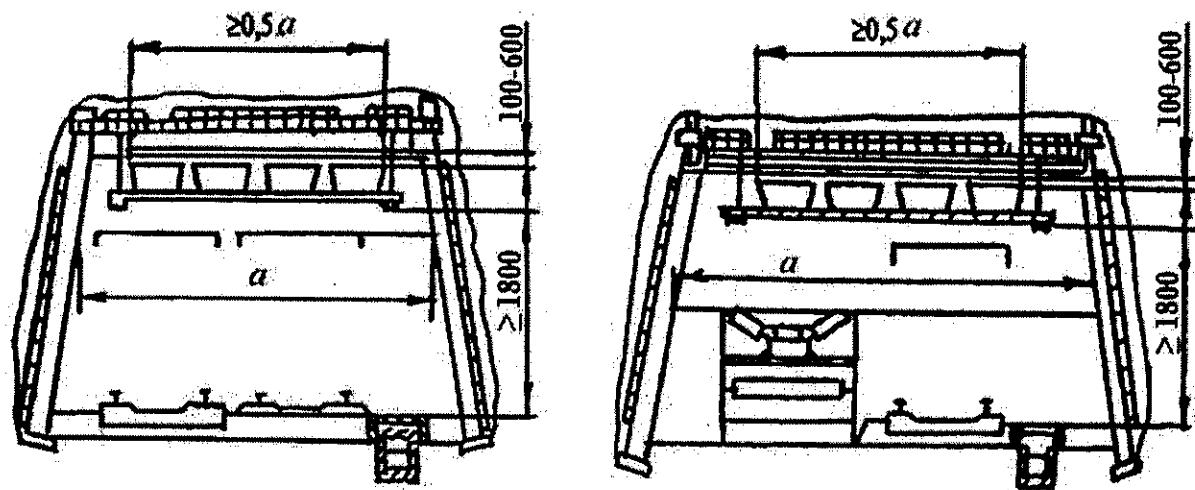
Схема установки водяных заслонов в выработках, закрепленных железобетонными стойками и шарнирно-подвесными верхняками
